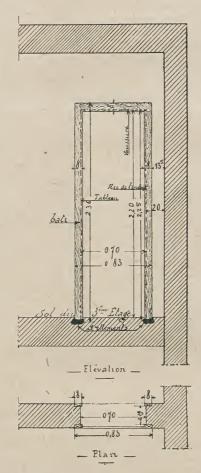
Élévation et plan d'une porte avec bâti et contre-bâti.
